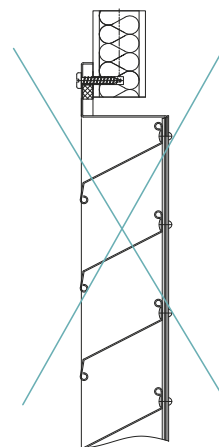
Montaż w ścianie murowanej lub betonowej.
